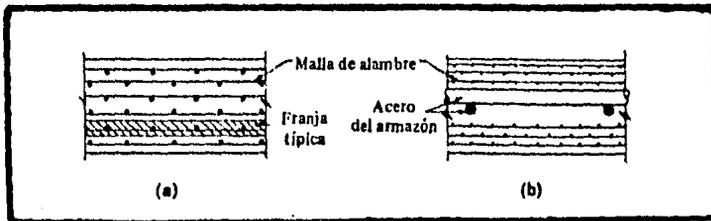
Sección transversal de una losa de ferrocemento.
